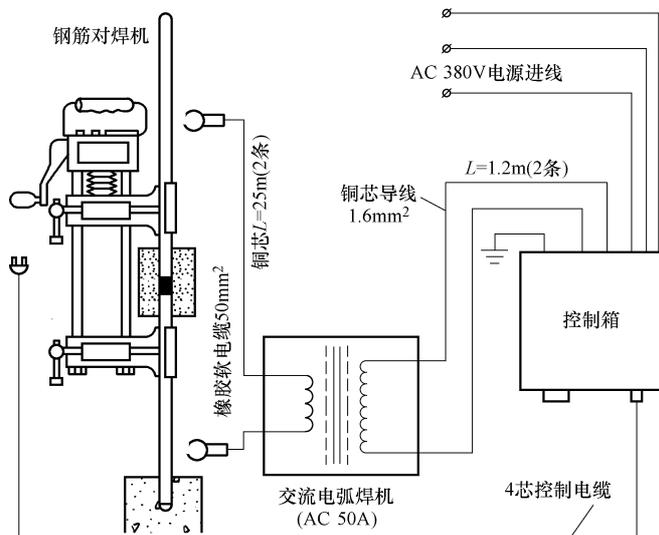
竖向钢筋电渣压力焊机接线图
